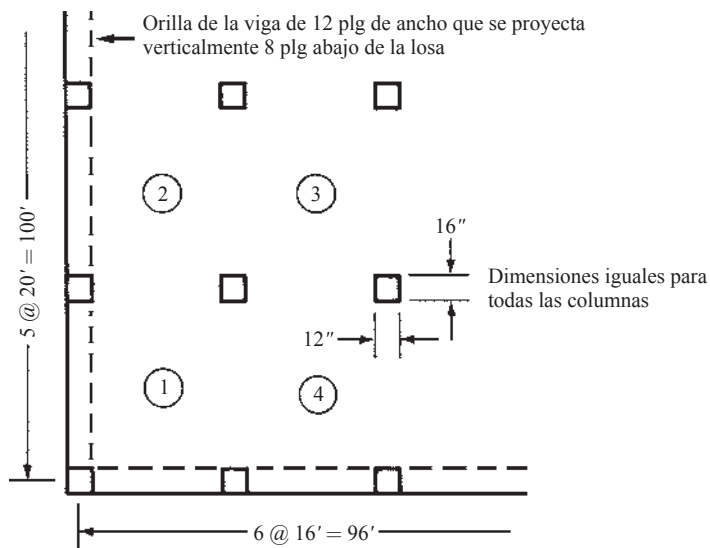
Una losa de piso de placa plana para el Ejemplo 16.1.
